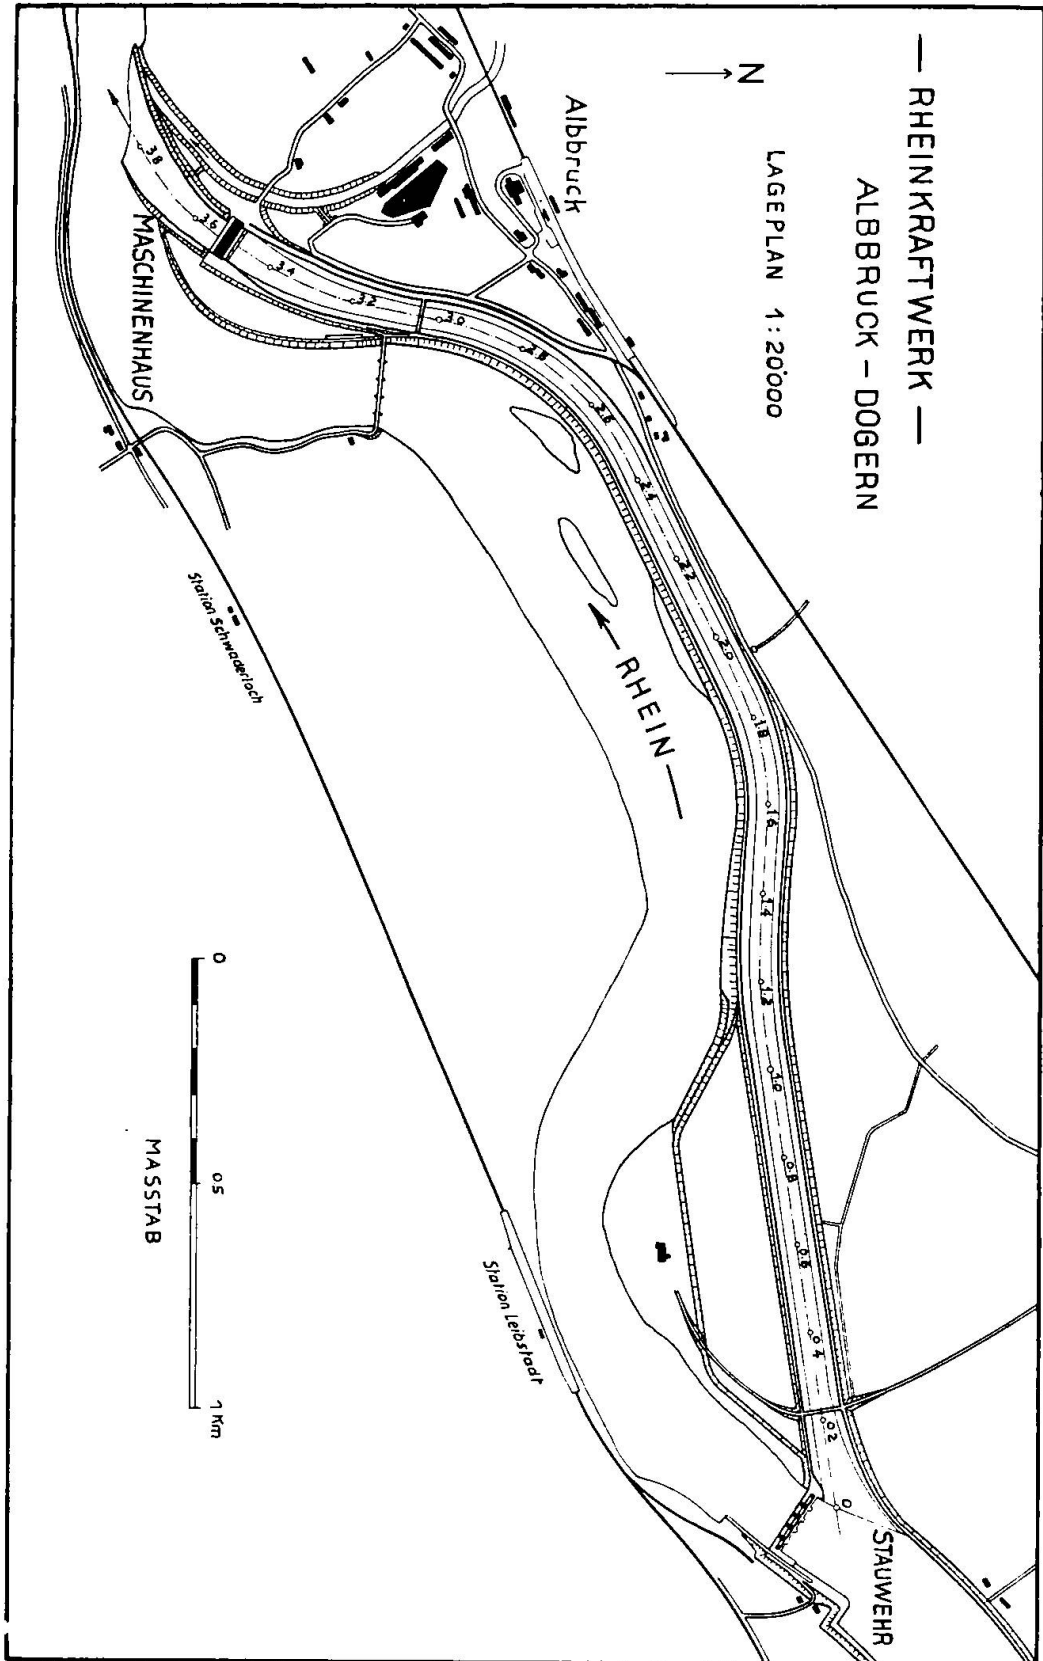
Rheinkraftwerk Albrück-Dogern. Lageplan 1 : 20 000.
